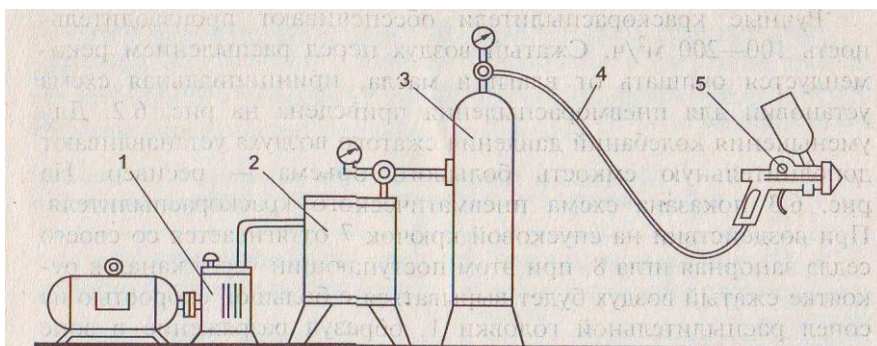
Схема установки для пневматического распыления: 1 — компрессор; 2 — маслоотделитель; 3 — ресивер; 4 — гибкий шланг; 5 — краскораспылитель
